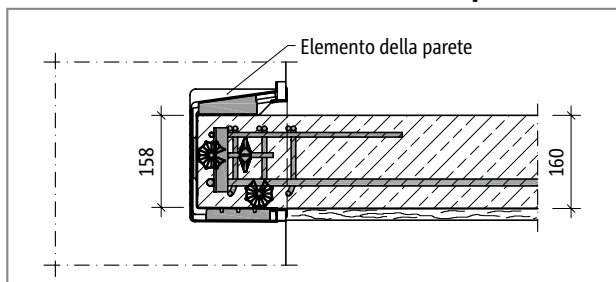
Schöck Tronsole® tipo Z, elemento della parete come cassaforma a perdere
